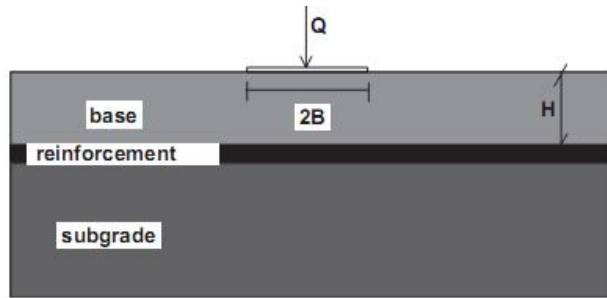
Section transversale type de bicouche renforcée par géogrilles
